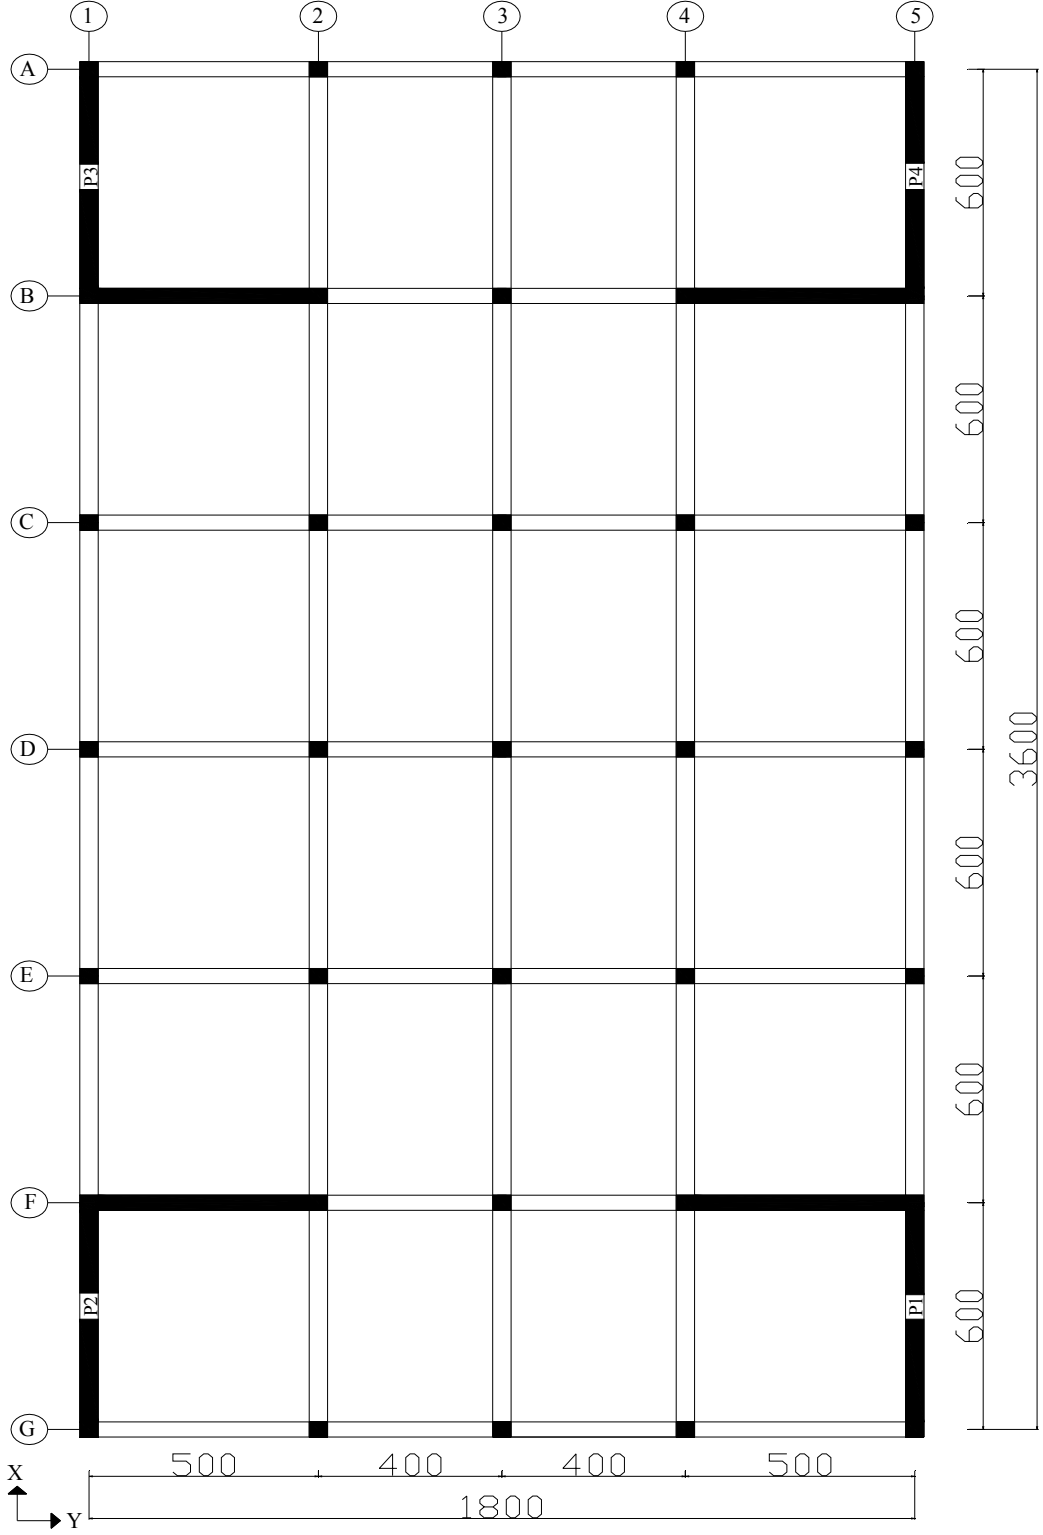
Örnek 5.19'un kat kalıp planı
